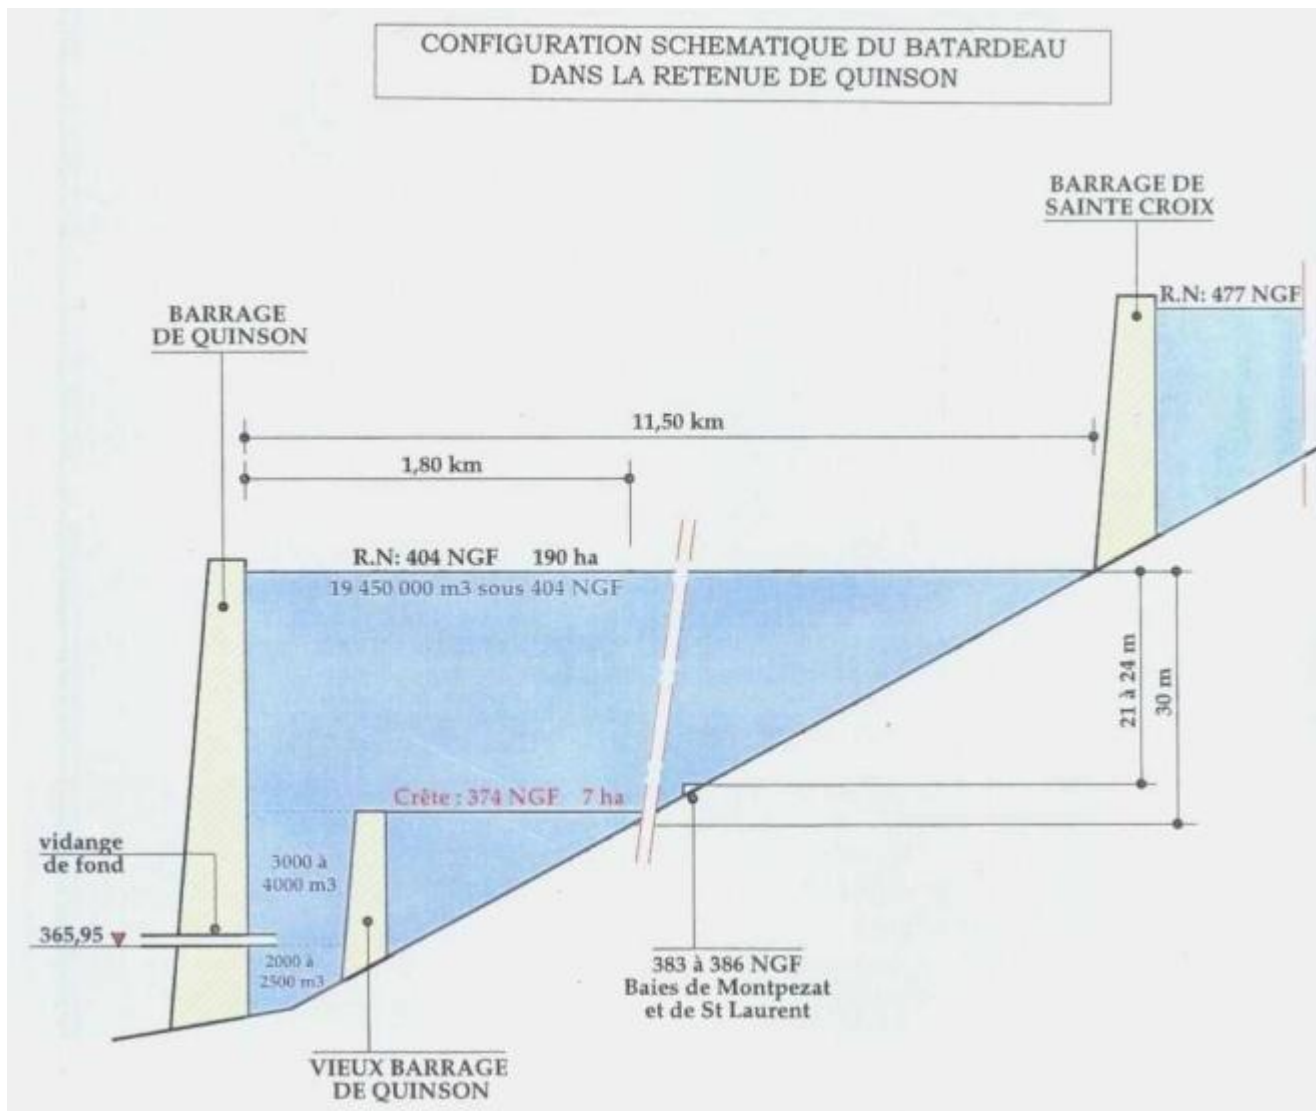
Batardeau amont («vieux barrage») dans la retenue de Quinson
